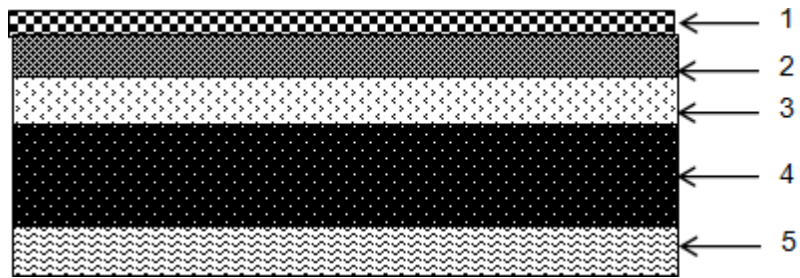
Coupe verticale du plancher en dalle pleine.
